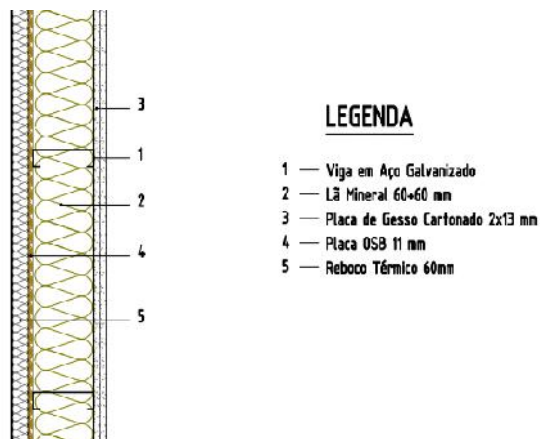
Envoltente exterior da construção em LSF (Adaptado Futureng)
